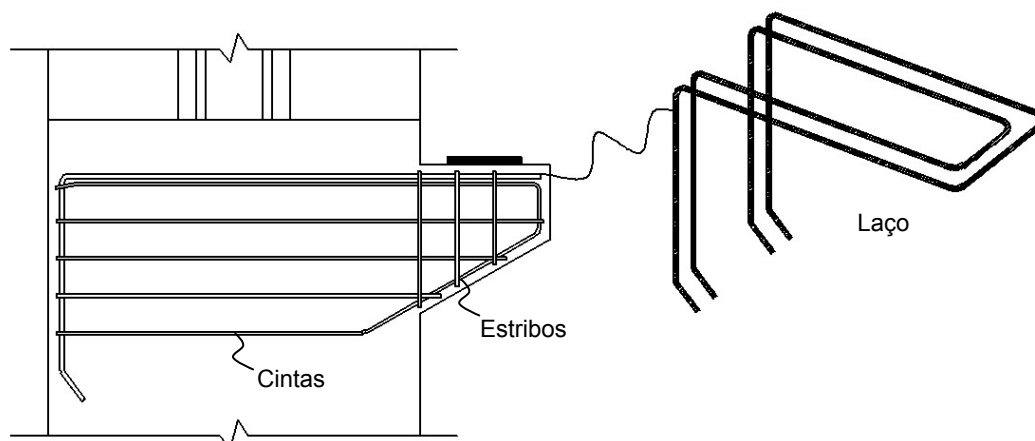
Pormenorização das armaduras nos cachorros (adaptado de [16])
